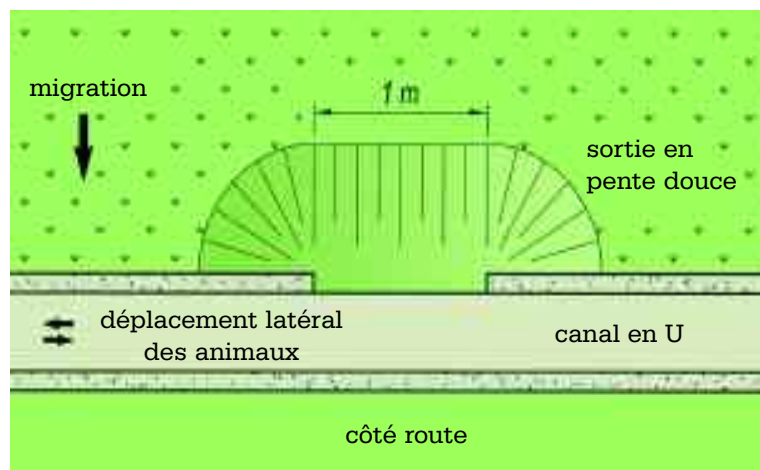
Rampe de sortie latérale le long d'un canal en U.
